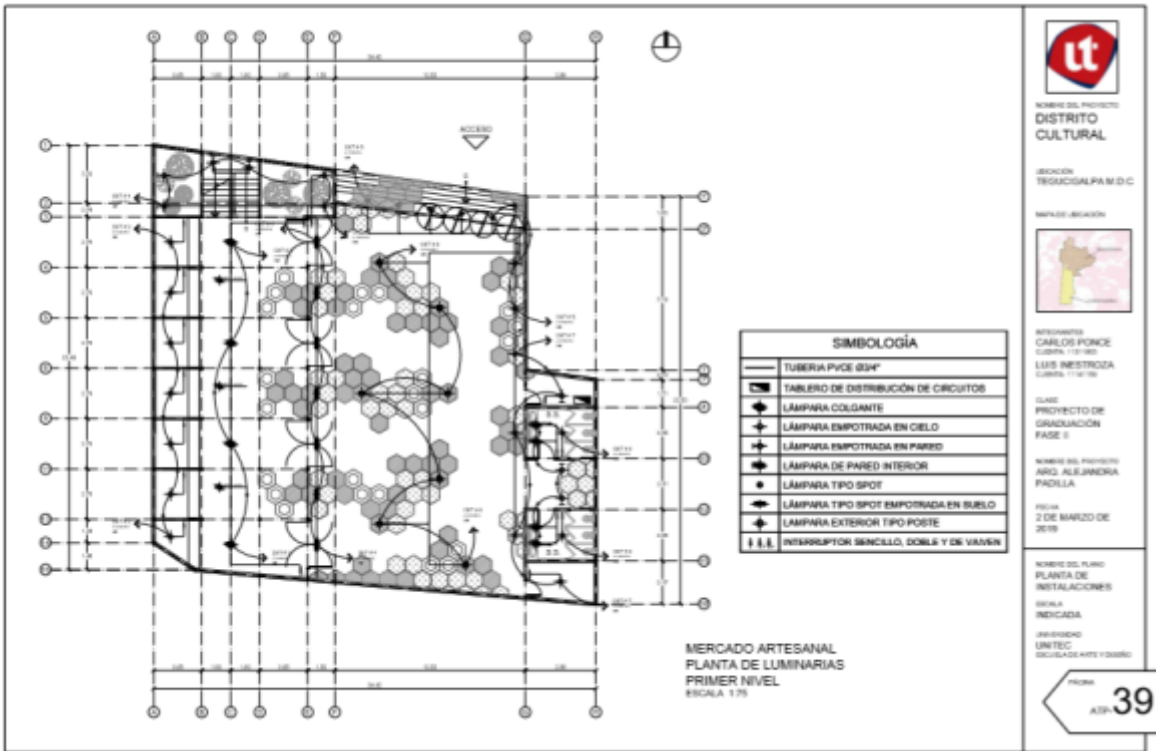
Plantas Luminarias Mercado Artesanal Primer Nivel
